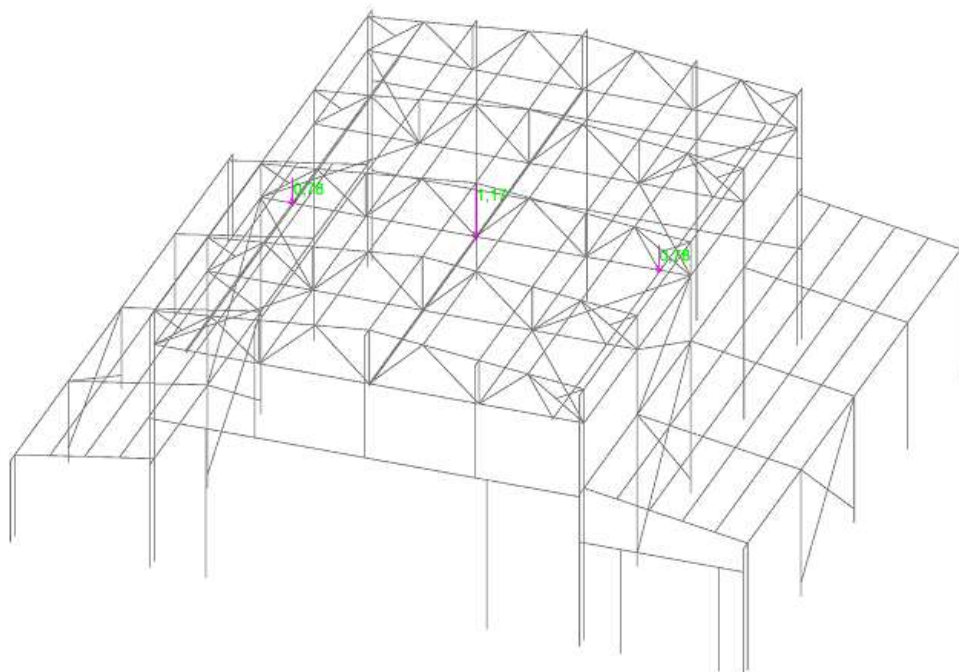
Схема загрузки постоянной крановой нагрузкой
